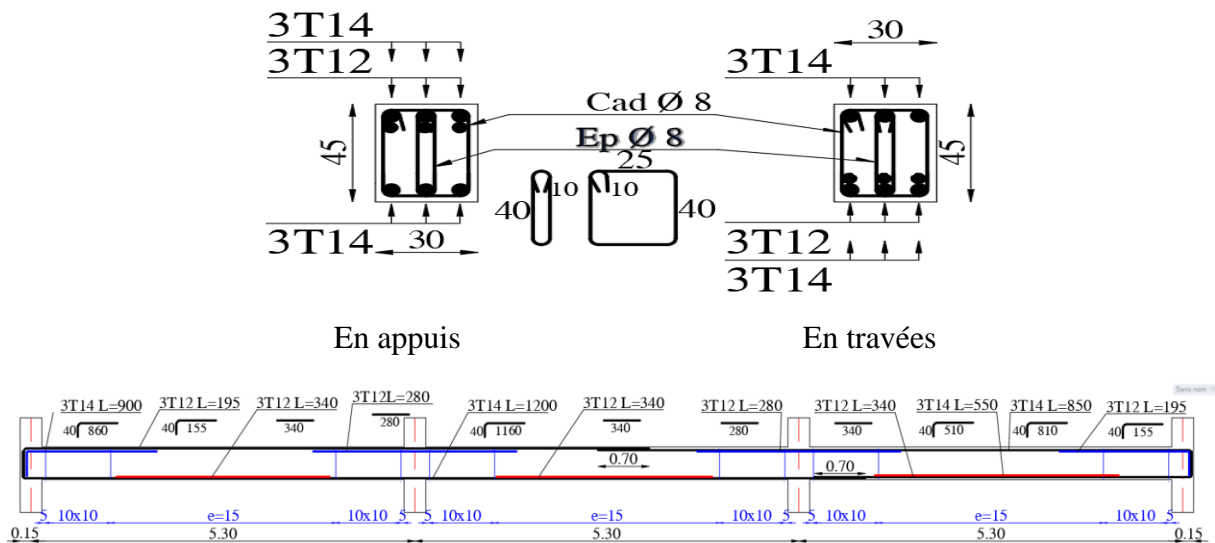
Schéma de ferrailage des poutres secondaires
